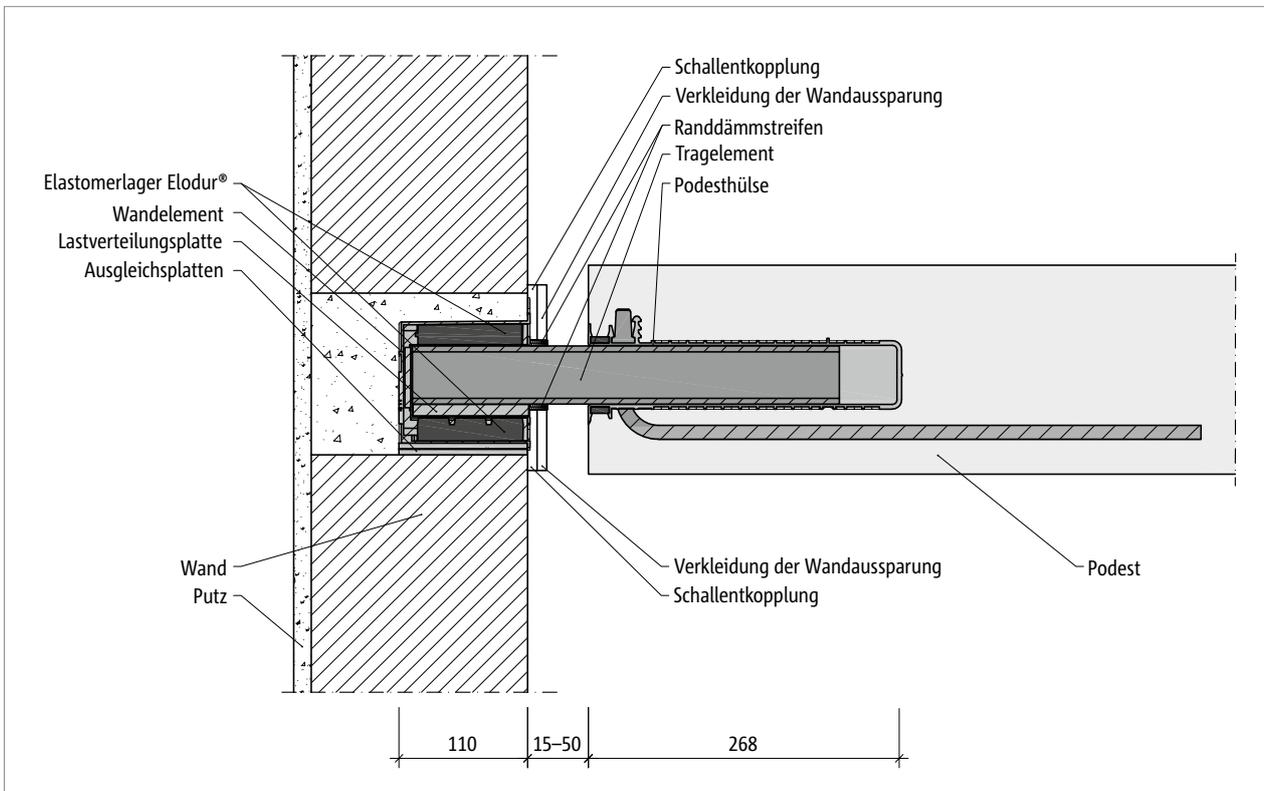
Schöck Tronsole® Typ P: Einbauschnitt mit Fertigteilpodest und Luftfuge
